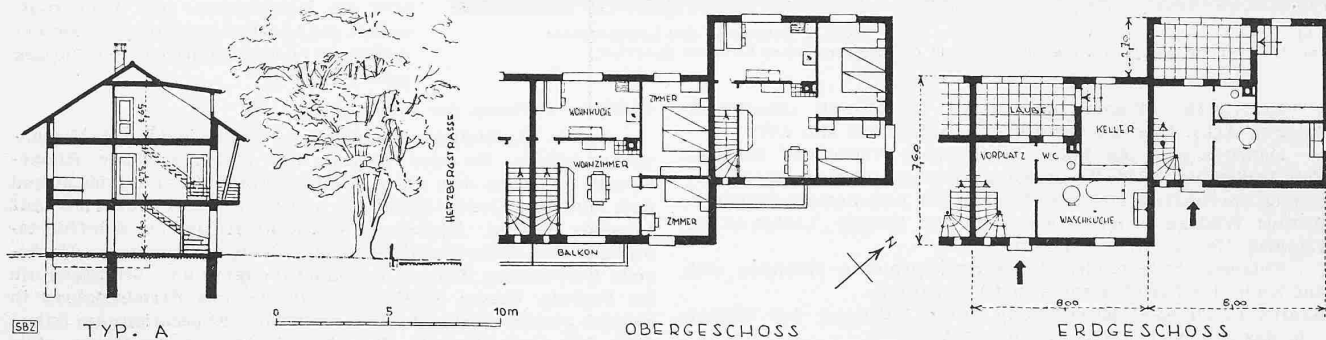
bis 4. Schnitt und Grundrisse 1:300 vom Typ A der Siedlung Scheibenschachen, Aarau
